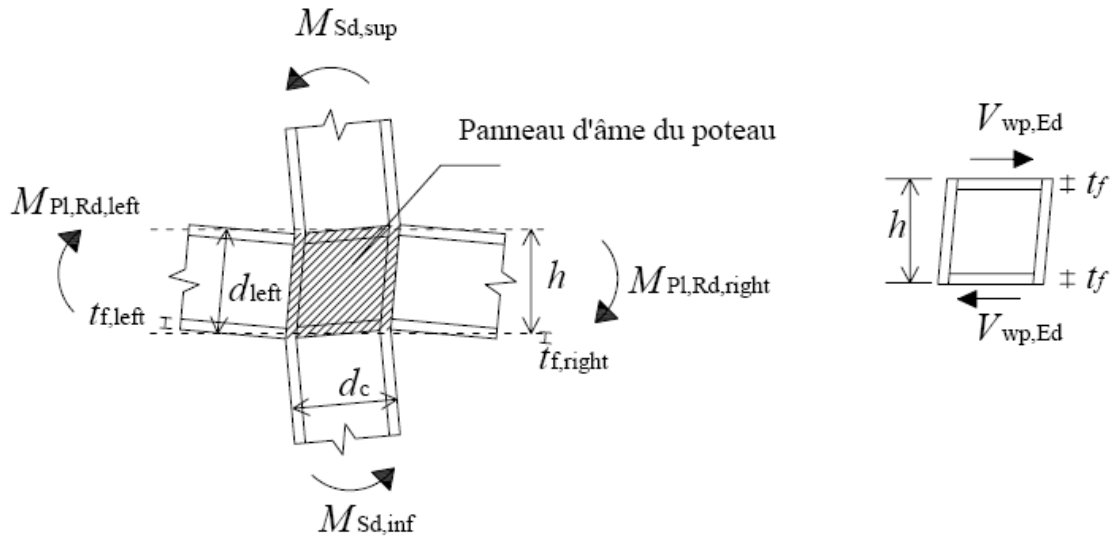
Sollicitation du panneau d'âme raidi d'un poteau
